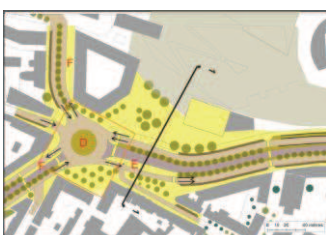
et 19 Plan et coupe PLURIS B. Bianchet
